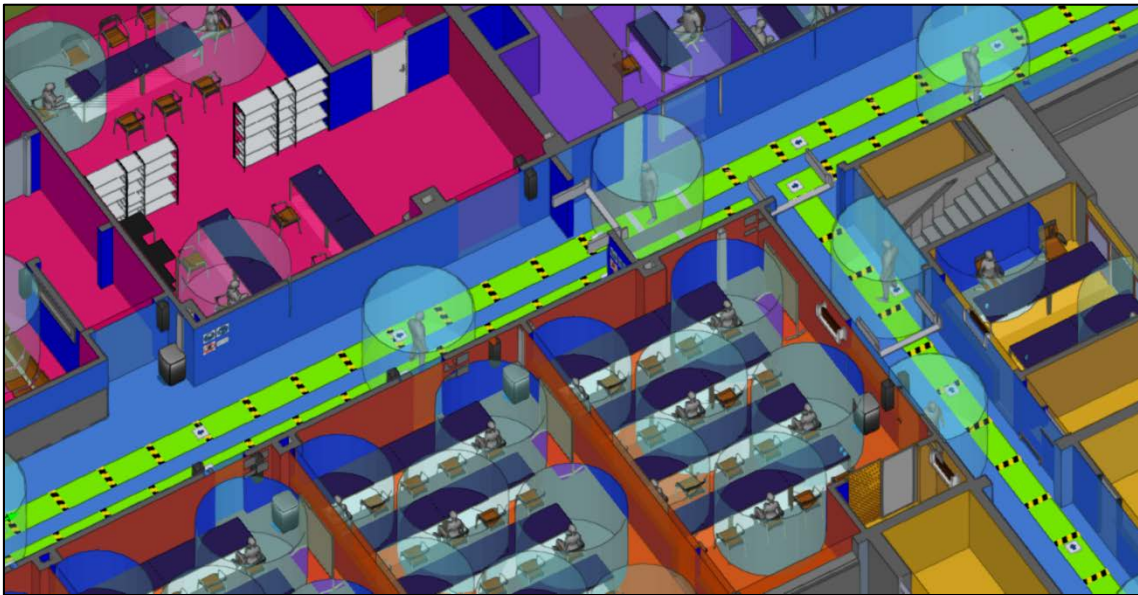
Open BIM COVID-19. Simulación 3: Vista 3D de la planta baja
